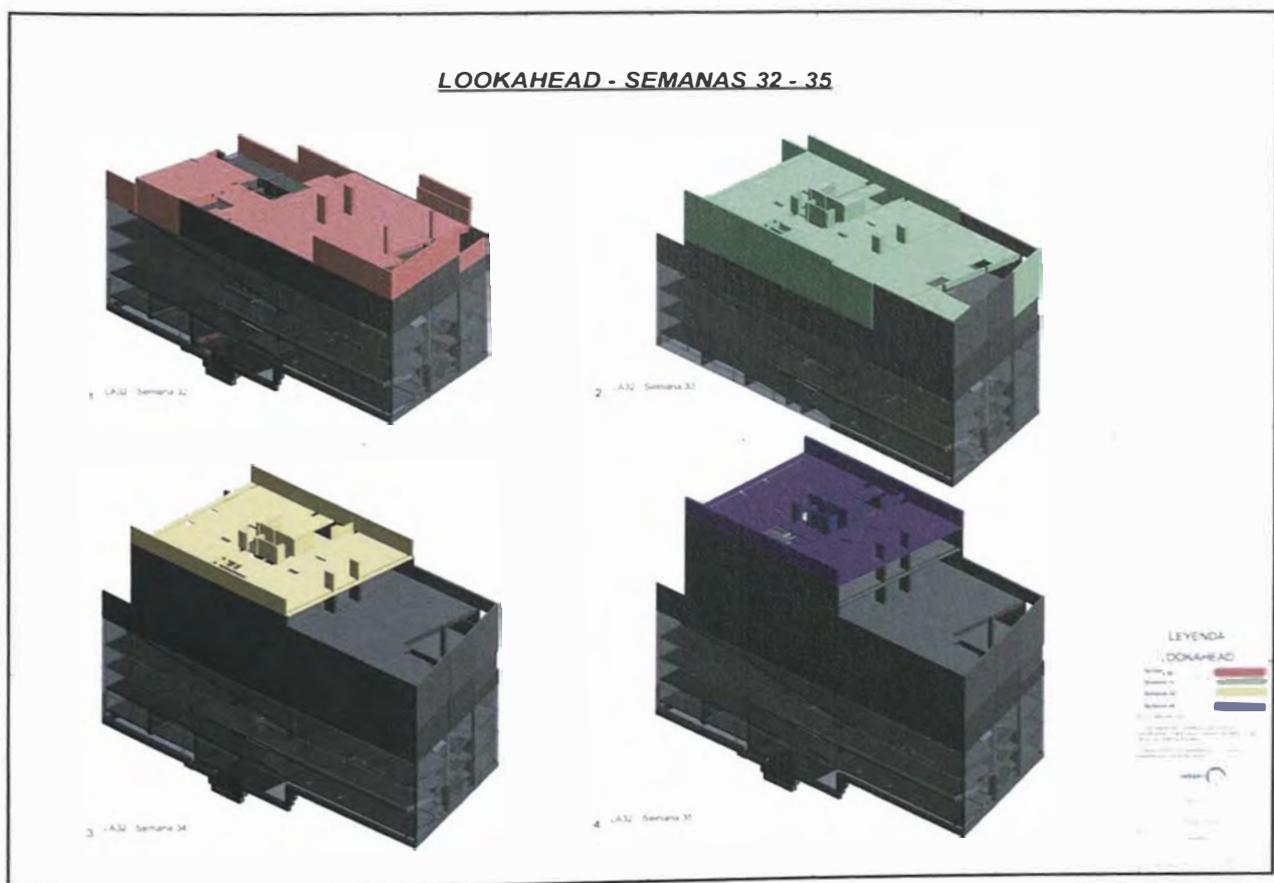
Uso del sistema Last Planner 4D para la elaboración del LookAhead
